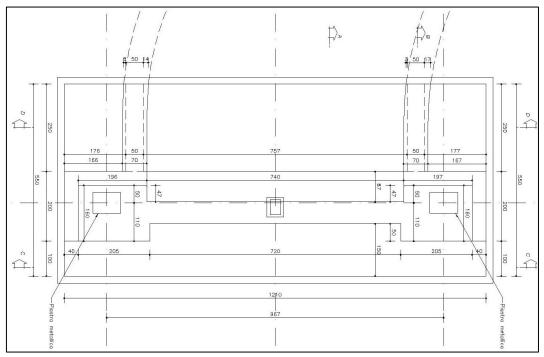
Carpenteria spalla da PE in revisione
